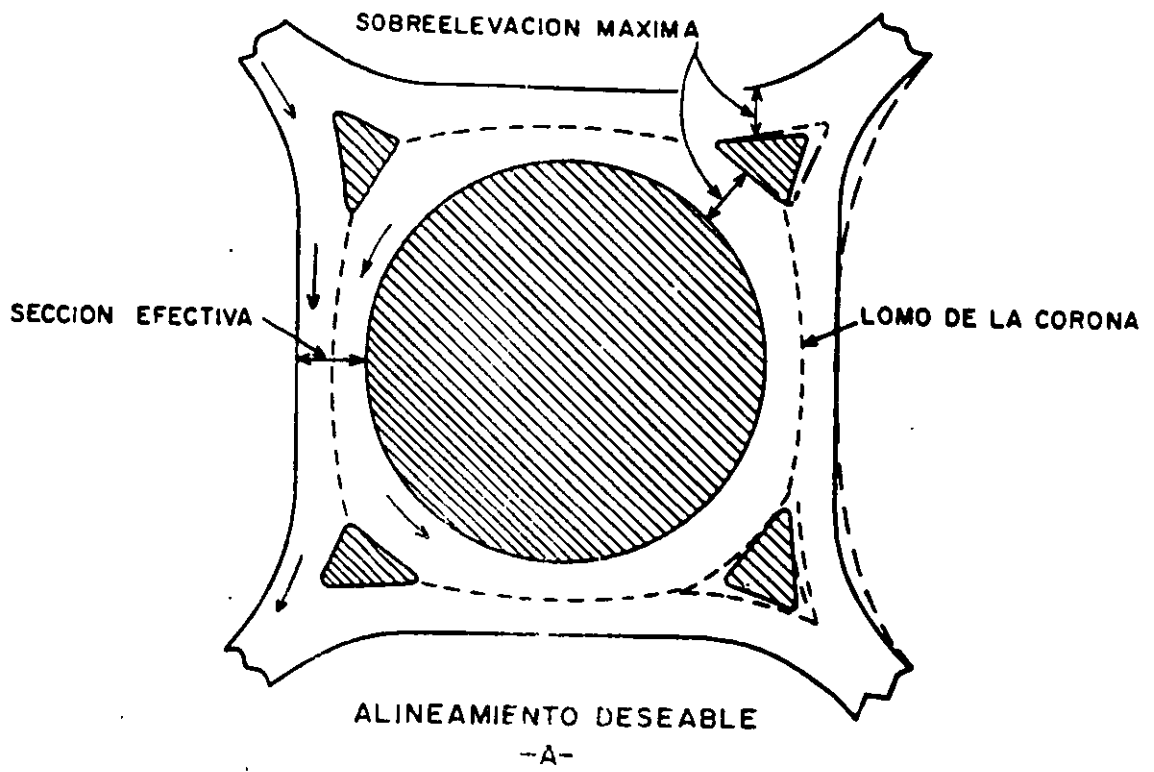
ALINEAMIENTO DE LA CALZADA DE LA GLORIETA
